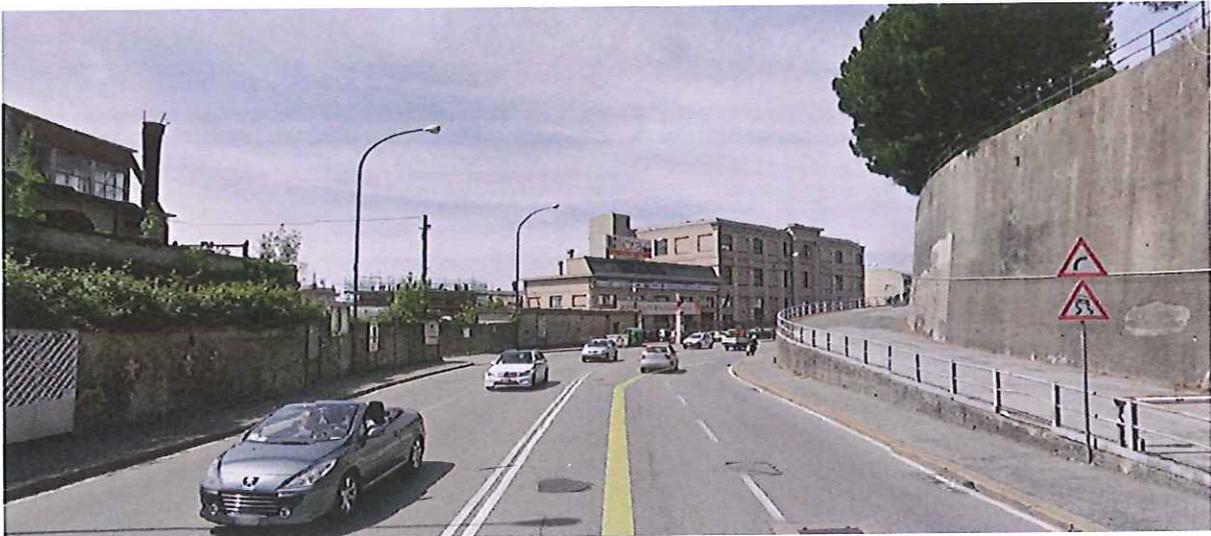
Vista (parziale) da levante dell'area su cui è prevista la realizzazione della rotatoria (sulla sinistra: scorcio dell'edificio ex Fonderie Ansaldo; sulla destra: muro di sostegno del terrapieno dell'insediamento Superba e rampa di accesso all'insediamento; sullo sfondo: edificio di Fabbricazioni Idrauliche).
